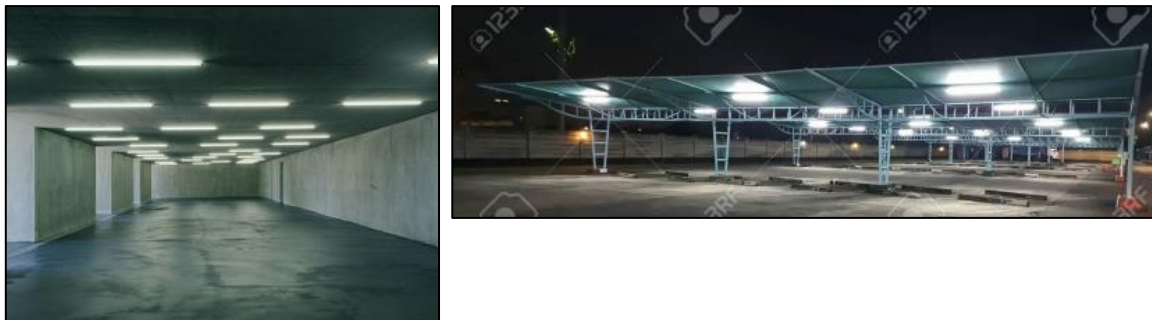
Plafonniers au niveau du parking -1 et des structures photovoltaïques
